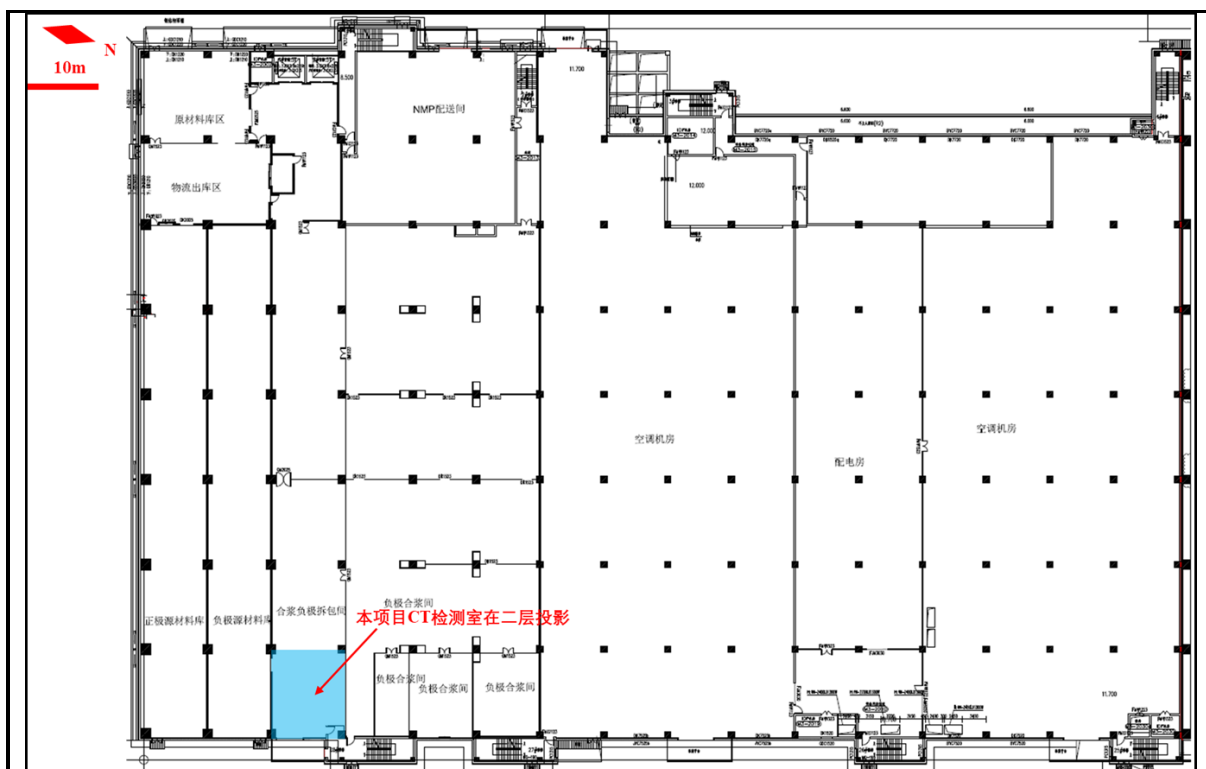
本项目所在 M3 厂房二层平面图（局部）
